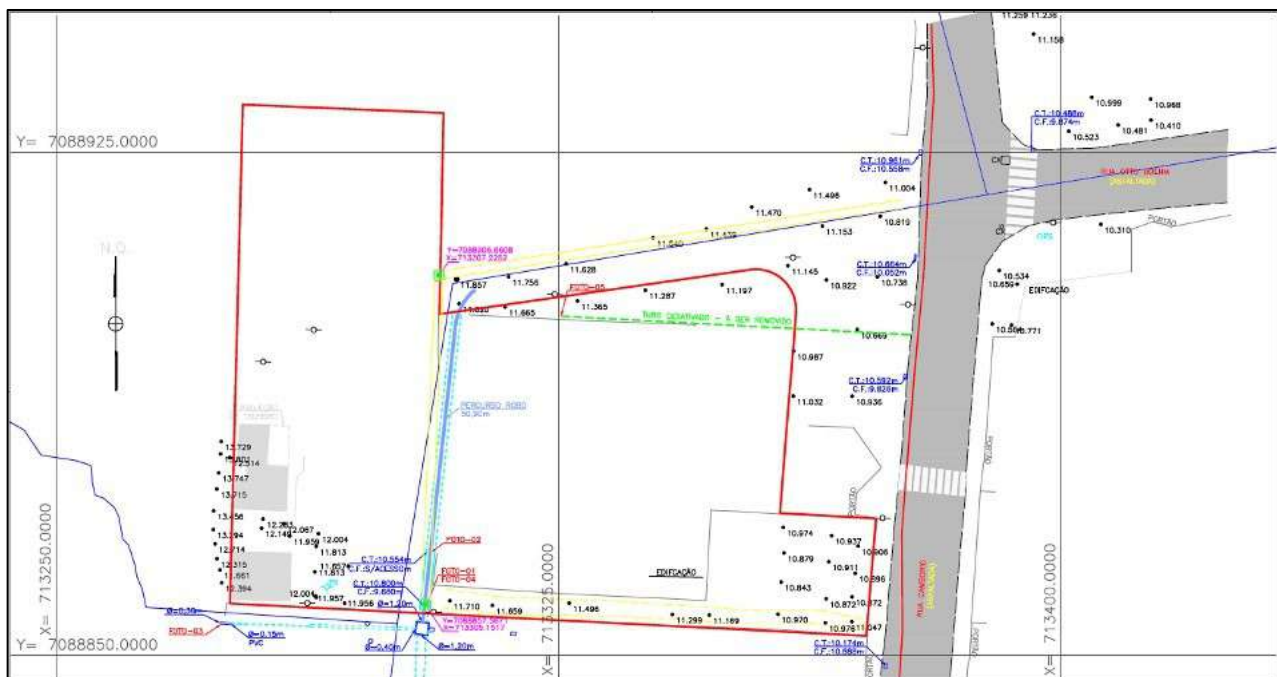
Planta de situação da rede de drenagem existente. Fonte: Progeo, 2026.
